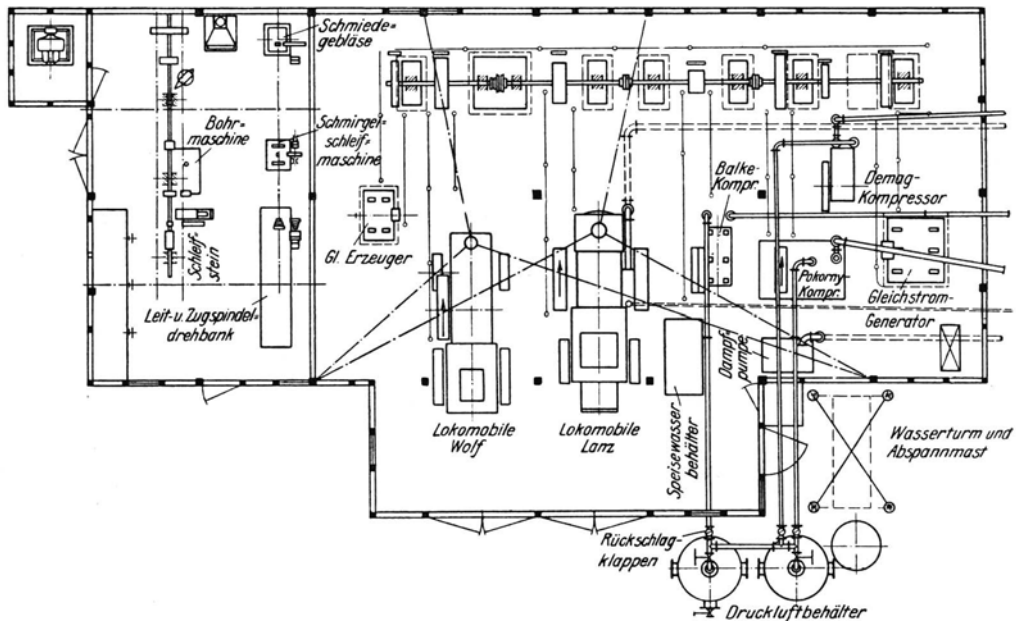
Grundriß der Maschinenanlage bei der Druckluftgründung des Fußgängerüberwegs unter der Spree in Berlin. (Nach La Baume: Bautechnik 1928 S. 42.)
